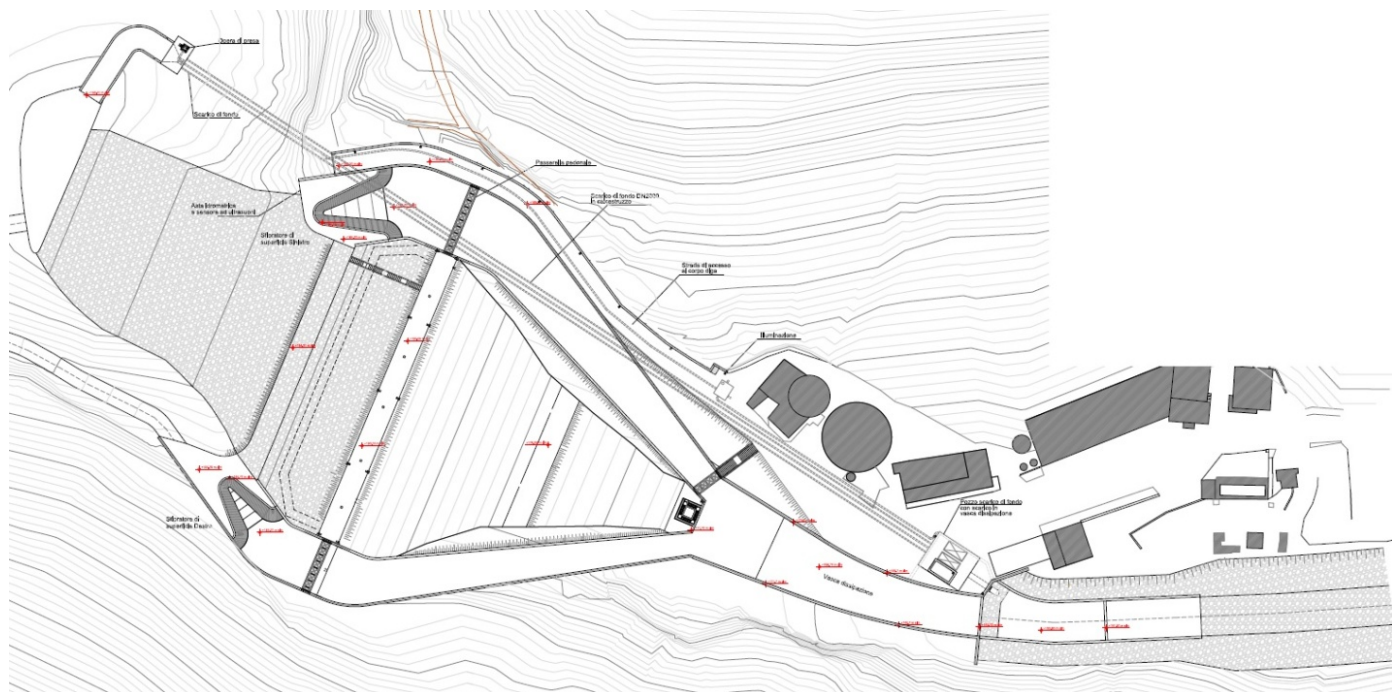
Planimetria della Diga Drove di Cepparello nello stato di progetto.
